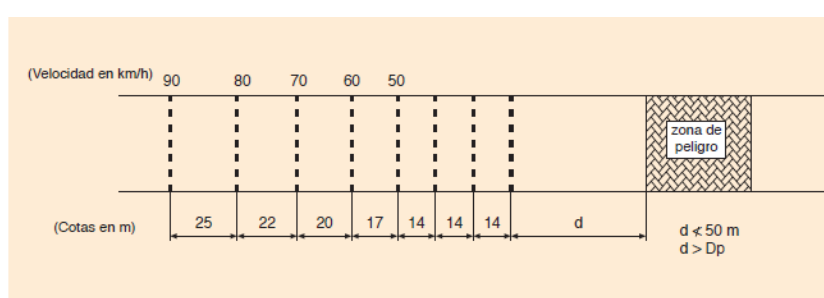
Disposición de bandas transversales de alerta. (Fuente: Orden FOM/3053/2008).
